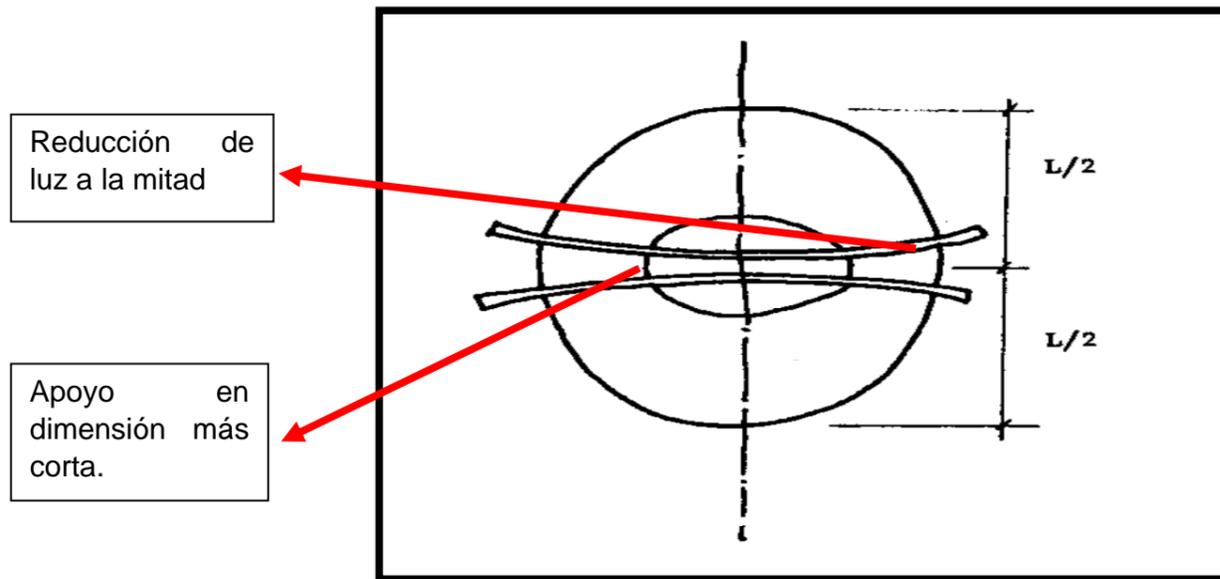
Planta elíptica, Fuente: e-Lexia.com
